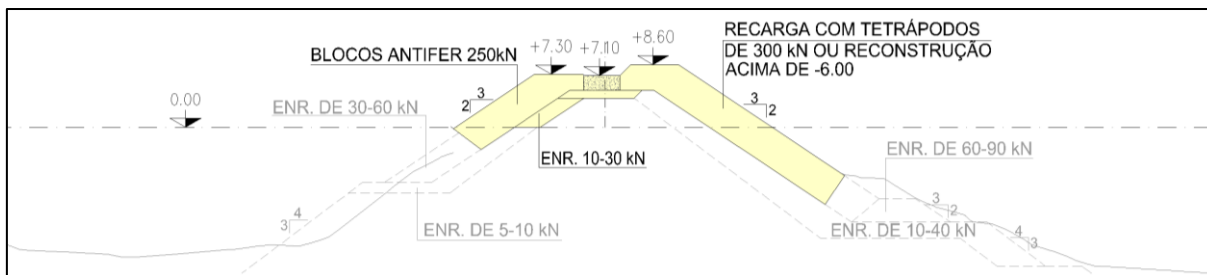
Perfil da Intervenção tipo 1 (IT1)
